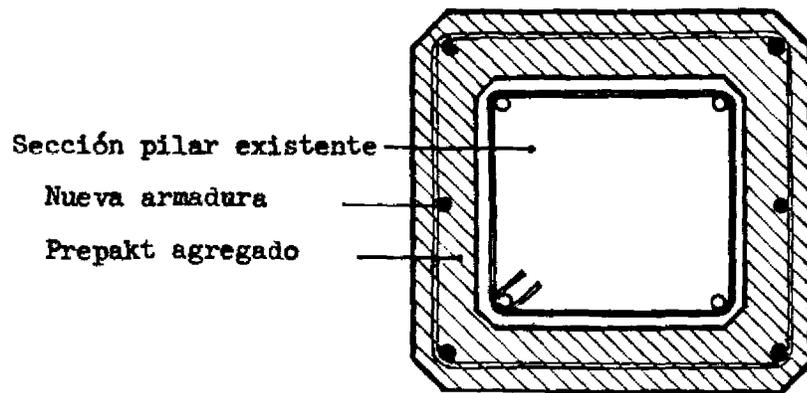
Caso P-3. JACKETING. AUMENTO DE LA SECCION CON HORMIGON INYECTADO Y NUEVAS ARMADURAS EN UN PILAR
